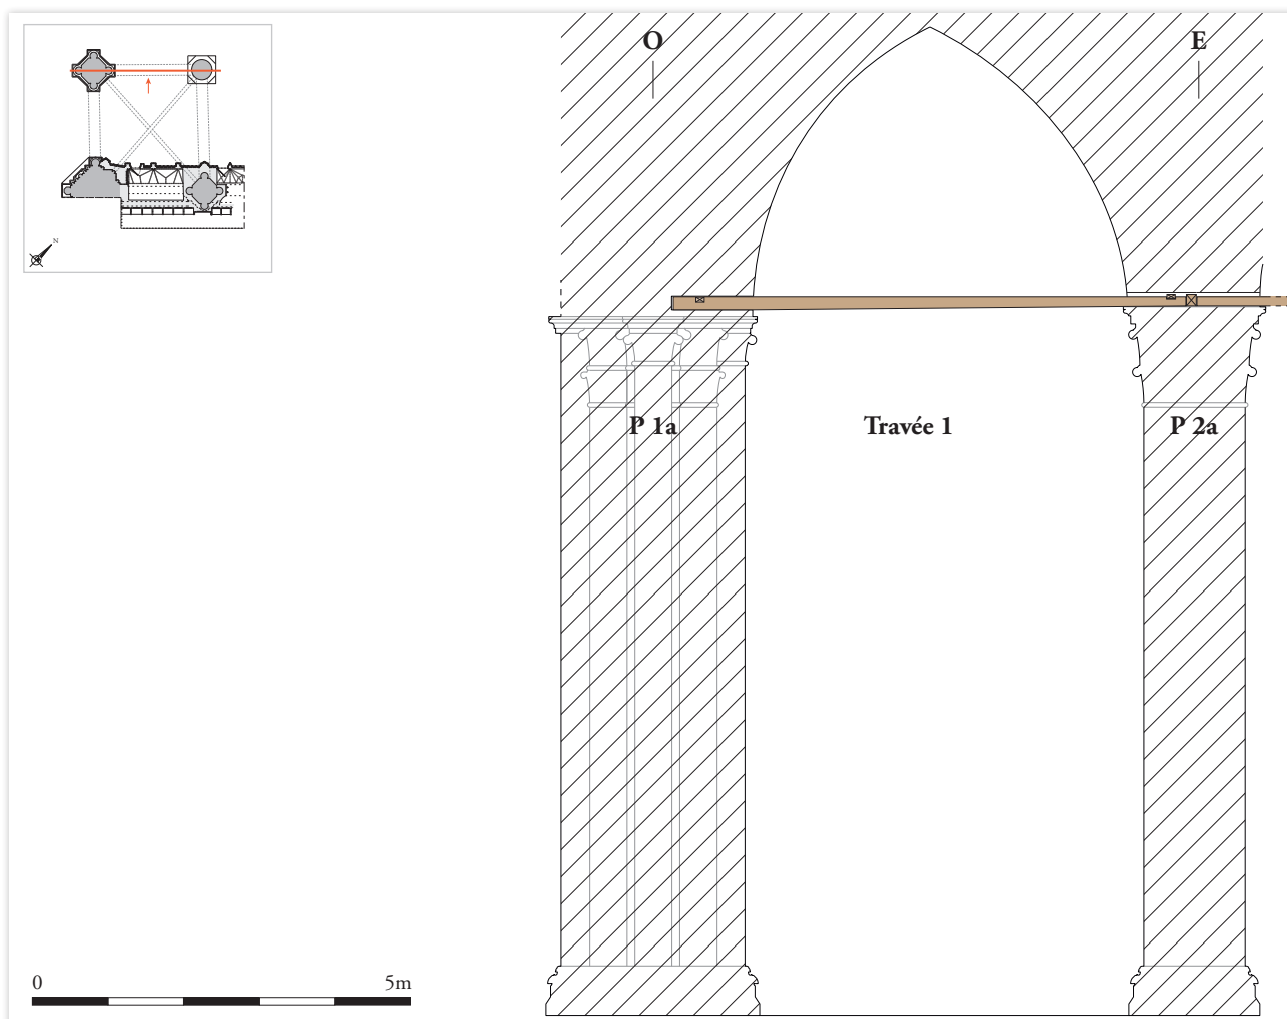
Coupe OUEST-EST des piliers P 1a et P 2a, restitution de la poutre – échelle : 1/100.
